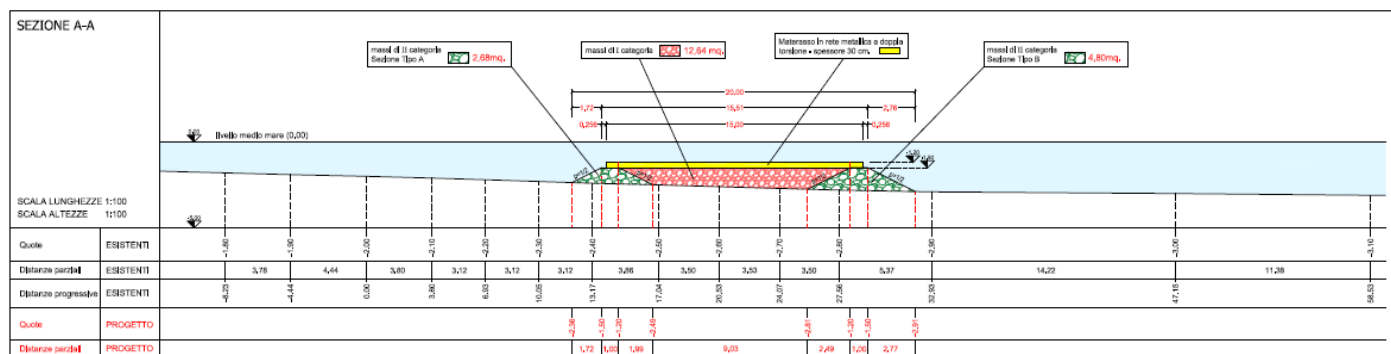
ALTERNATIVA 1 - Sezione di progetto costa-largo.
